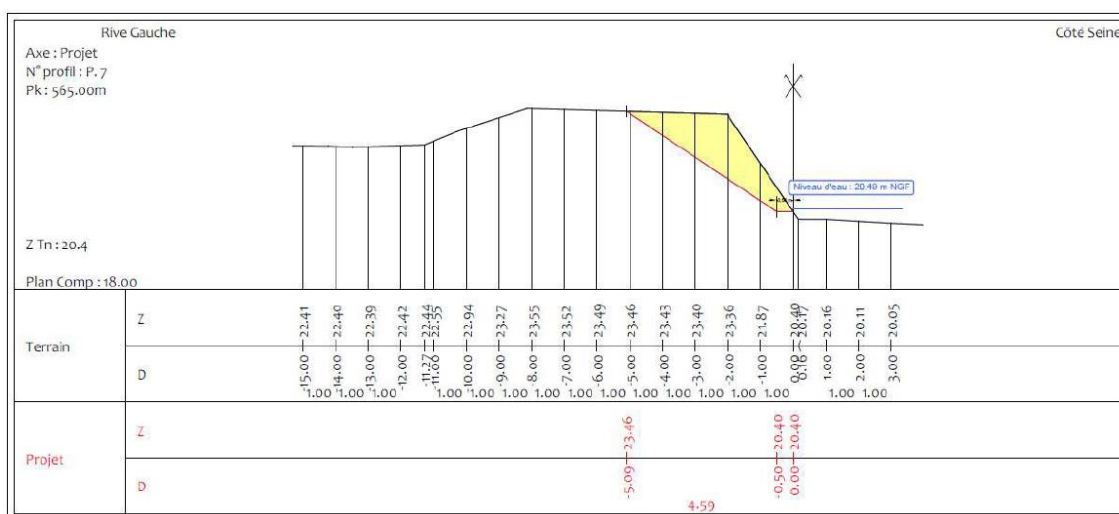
Présentation d'une coupe type des travaux de reprofilage
